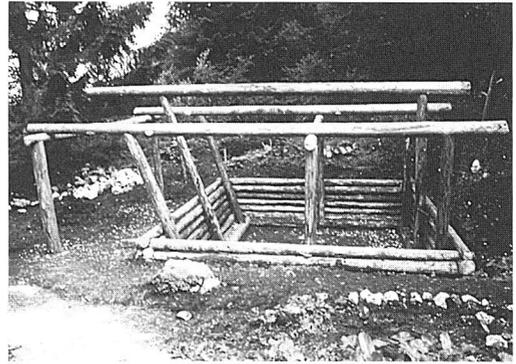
Die rekonstruierte Anlage mit eingetiefter Blockwanne und Dachkonstruktion auf Schwellbalken.
